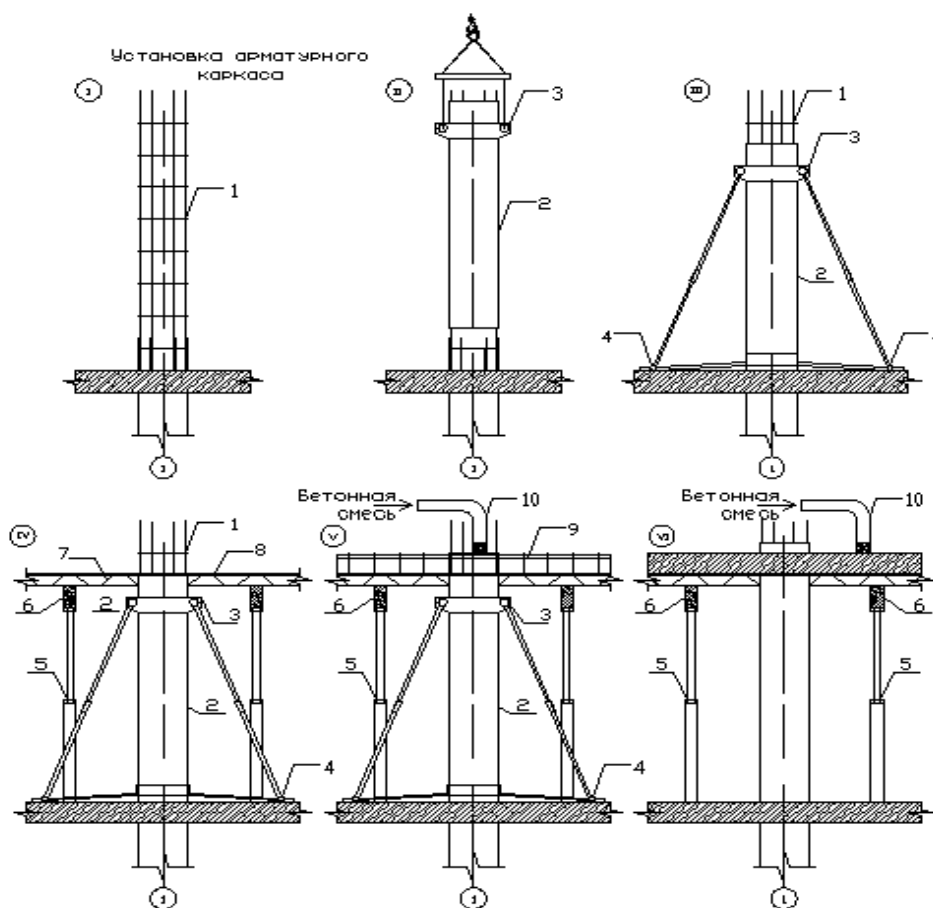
Технологическая схема возведения несущих конструкций каркаса здания: I – установка арматурного каркаса; II – установка несъемной трубчатой опалубки; III – выверка, временное закрепление несъемной трубчатой опалубки; IV – установка опалубки перекрытия; V – бетонирование колонны и последующее армирование плиты перекрытия; VI – бетонирование плиты перекрытия. Обозначения: 1 – арматурный каркас; 2 – несъемная опалубка; 3 – крепежная гильза; 4 – монтажный подкос; 5 – телескопическая опорная стойка; 6 – главная балка щитов опалубки; 7 – второстепенная балка щитов опалубки; 8 – щиты опалубки перекрытия; 9 – арматурный каркас плиты перекрытия; 10 – бетонолитная труба.
